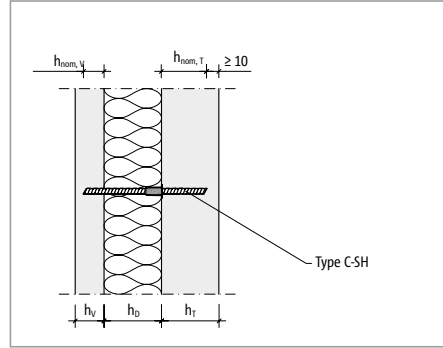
Schöck Isolink® type C-SH : données de la section du mur sandwich ;  $h_{nom,V} < h_V$
